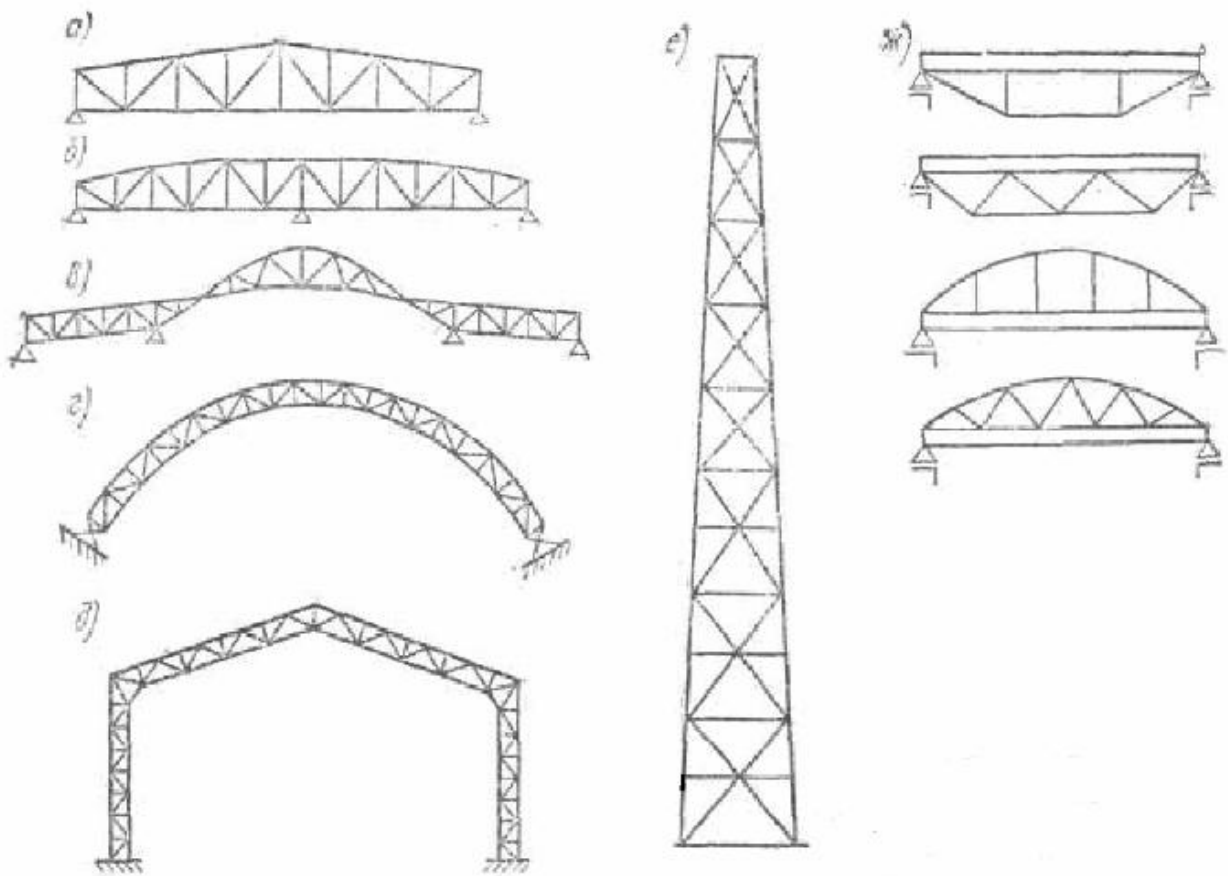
Системы ферм: а – балочная; б – неразрезная; в, е – консольная;
